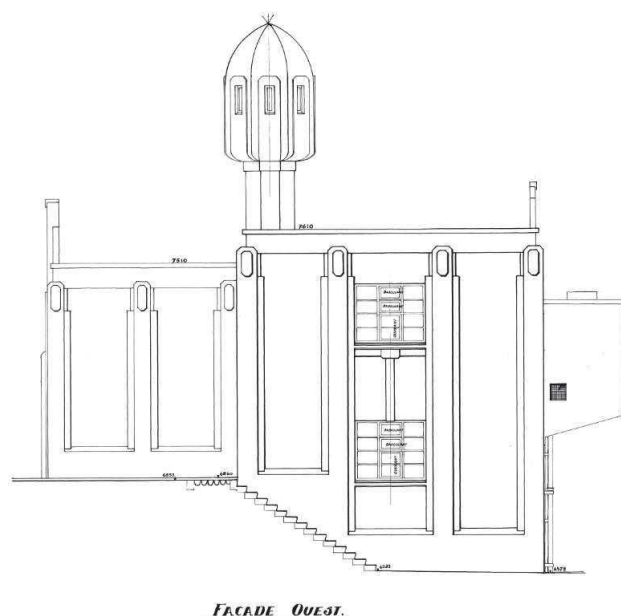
Élévation de la façade Ouest - ech. 1/200
